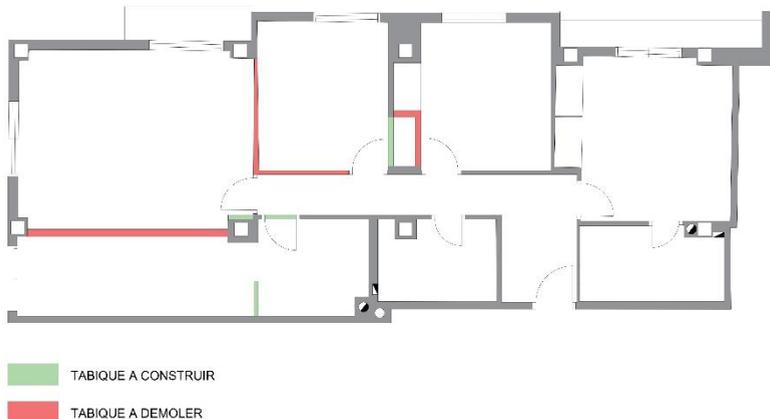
Plano de tabiques a demoler y construir. Fuente propia.
